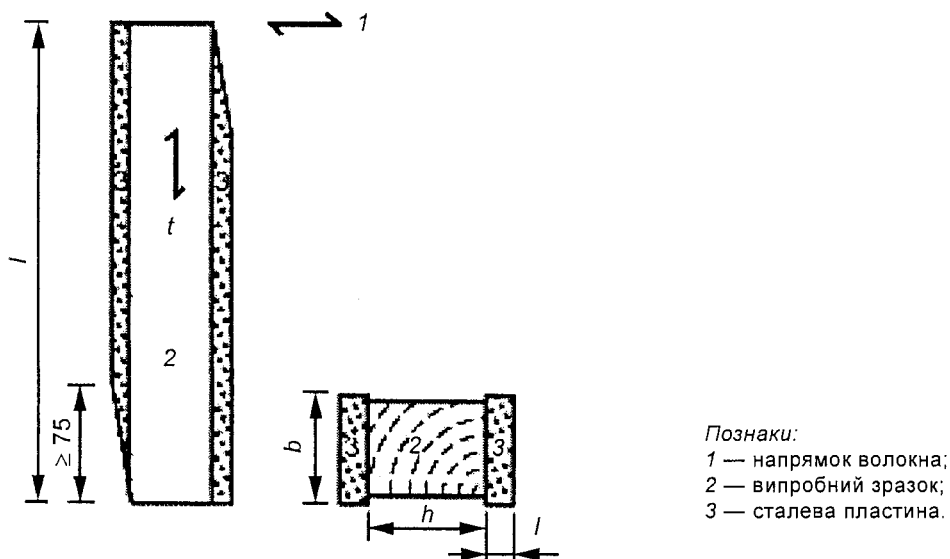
Випробний зразок, склеєний зі сталевими пластинами
